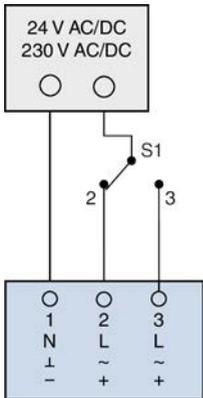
AUF/ZU-Steuerung mit Wechsler
